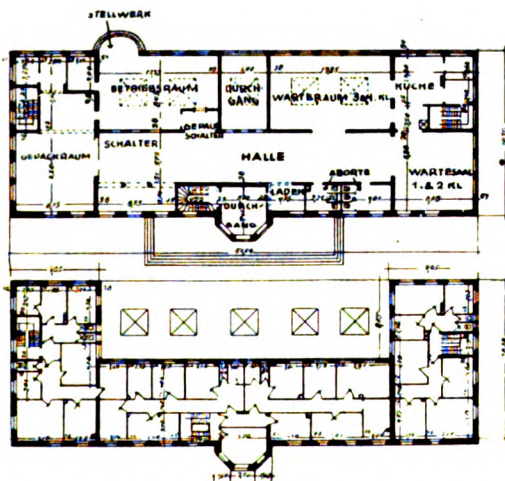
Grundriß des Betriebshauptgebäudes im Bahnhof Bad Tölz.
